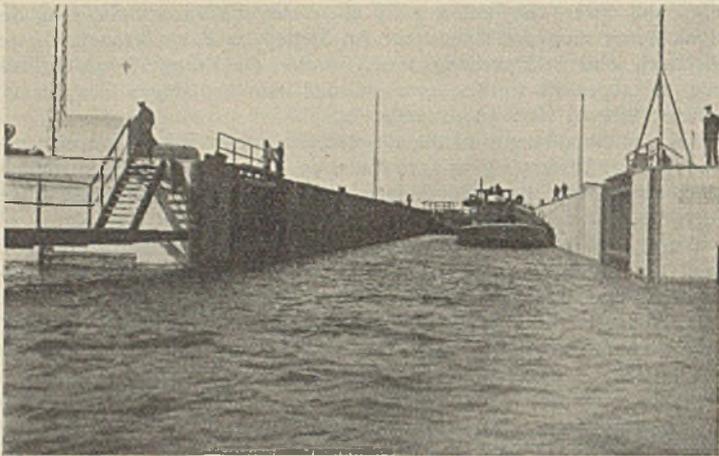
Zweite Schleuse Dörverden. Ansicht vom Unterwasser.
